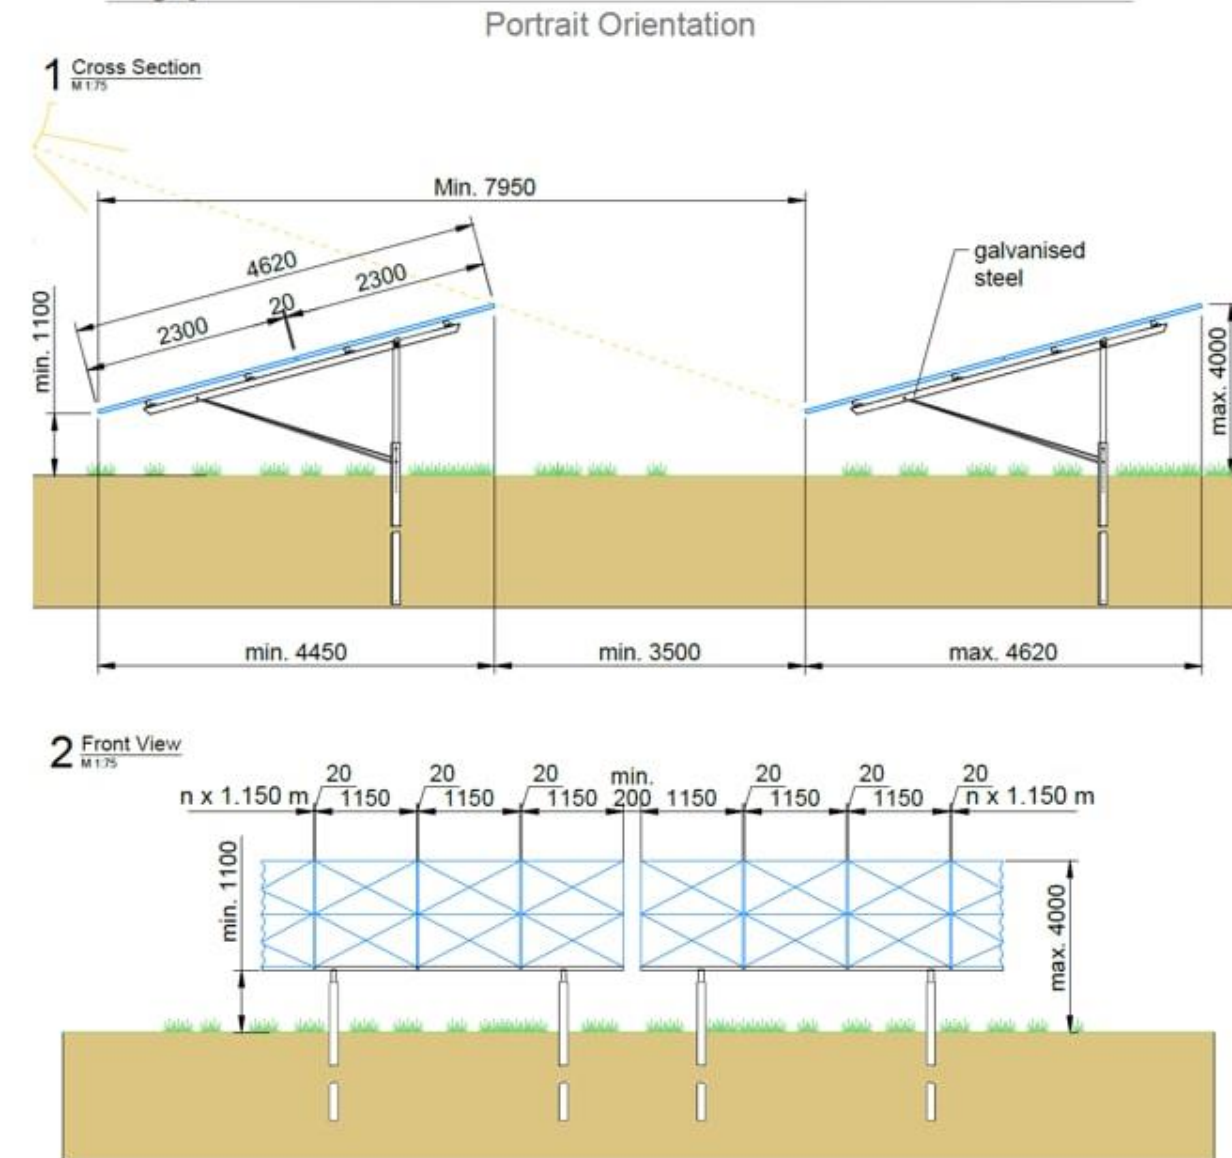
Plan des structures de la centrale (source : ib vogt)
